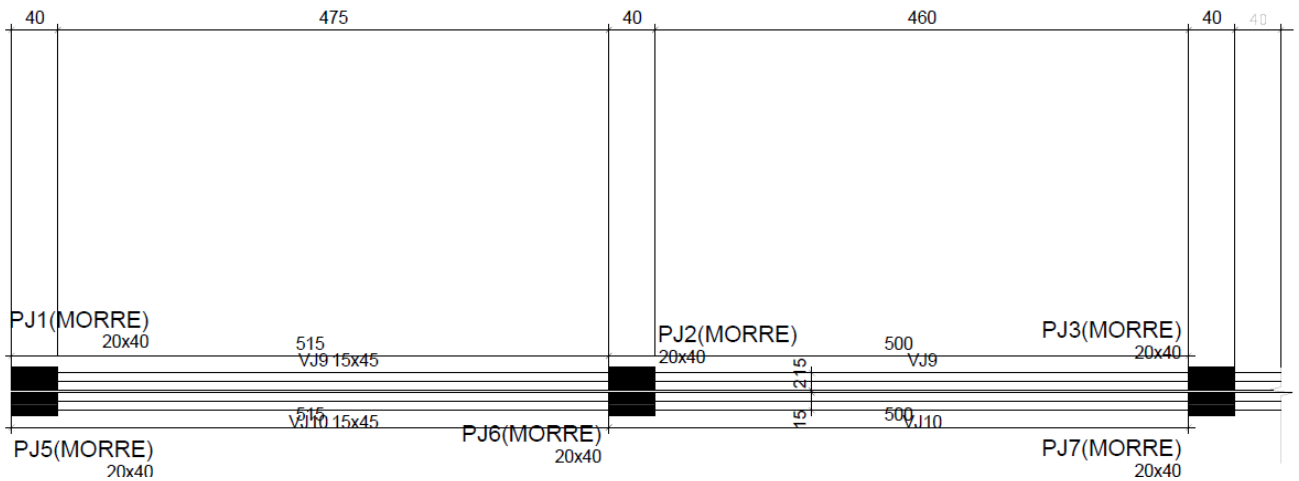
Vigas à serem reforçadas na junta da garagem (Seção A)
